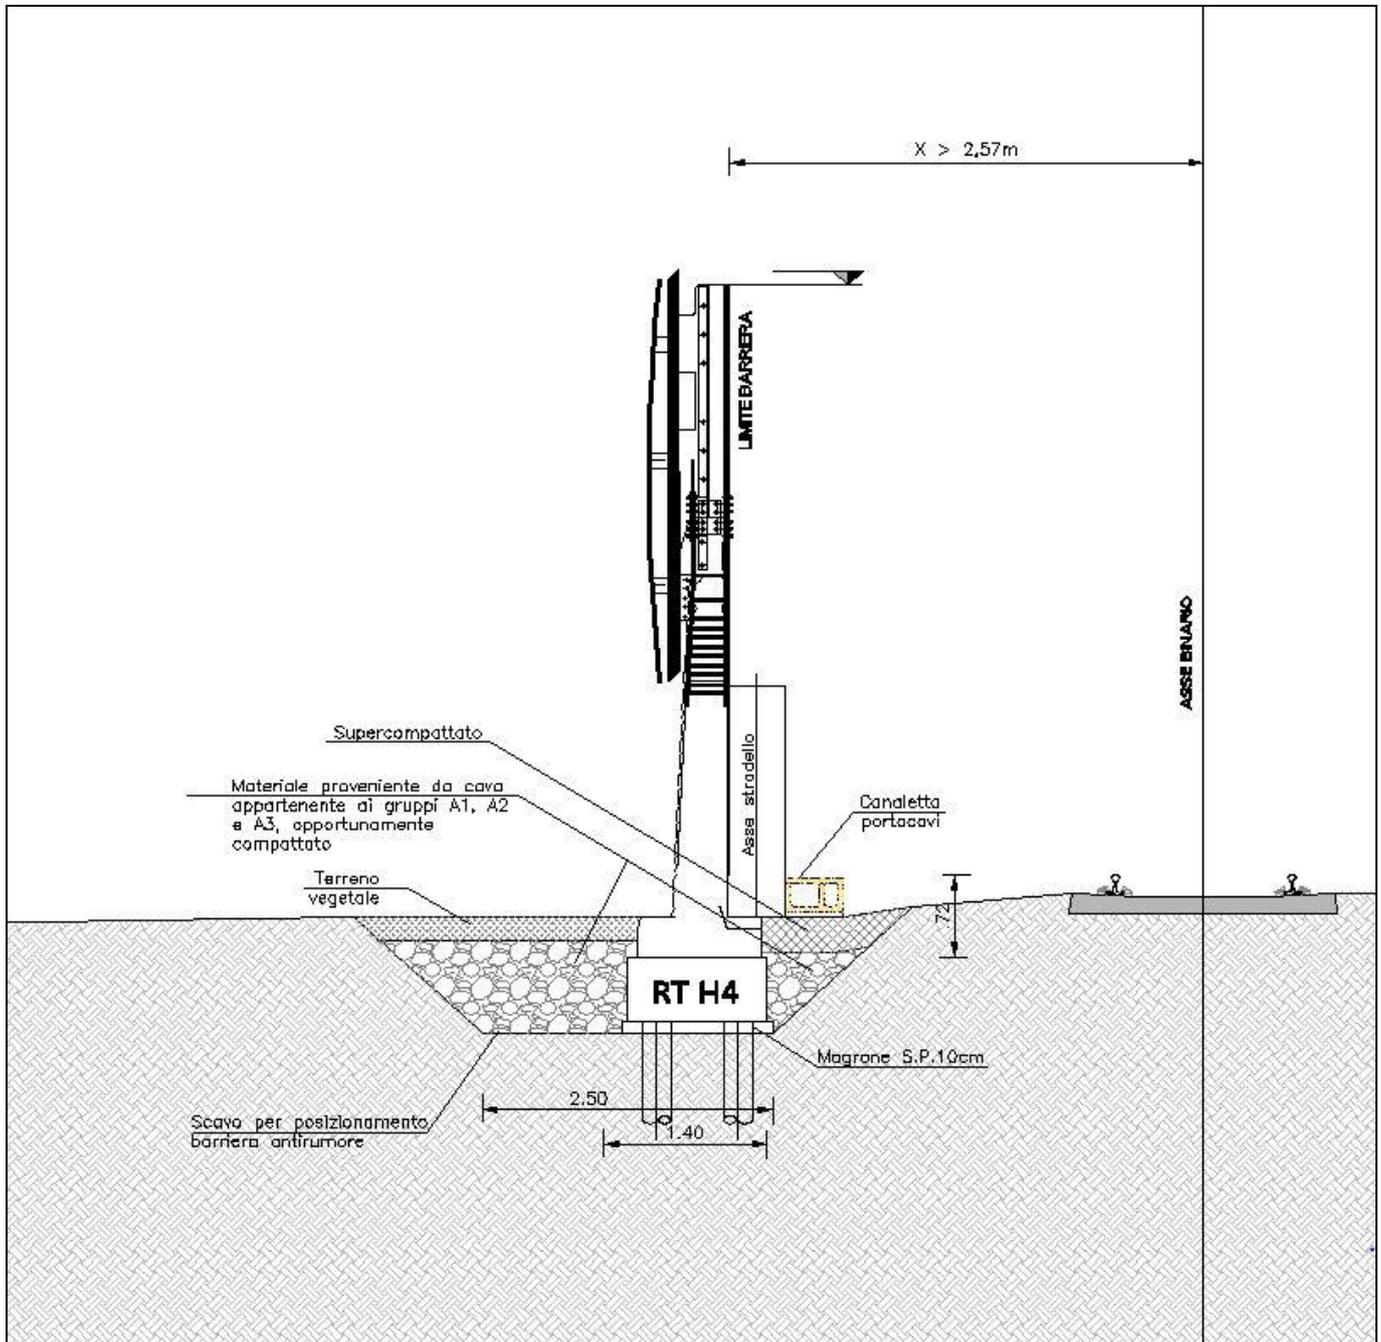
Sezione trasversale tipo con barriera rettificata H4
